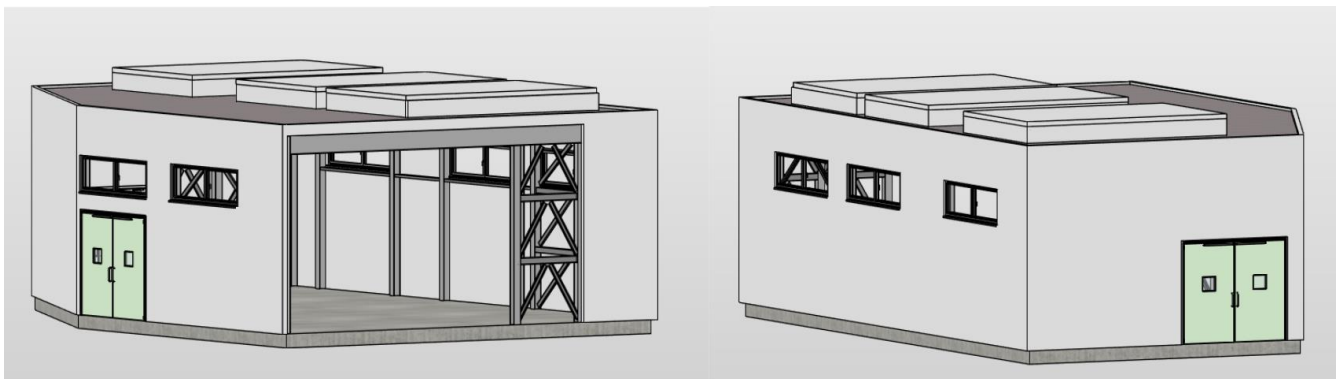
Nachmodellerte maschinelle Vorklärung mit Stahl-Sandwichfassade
